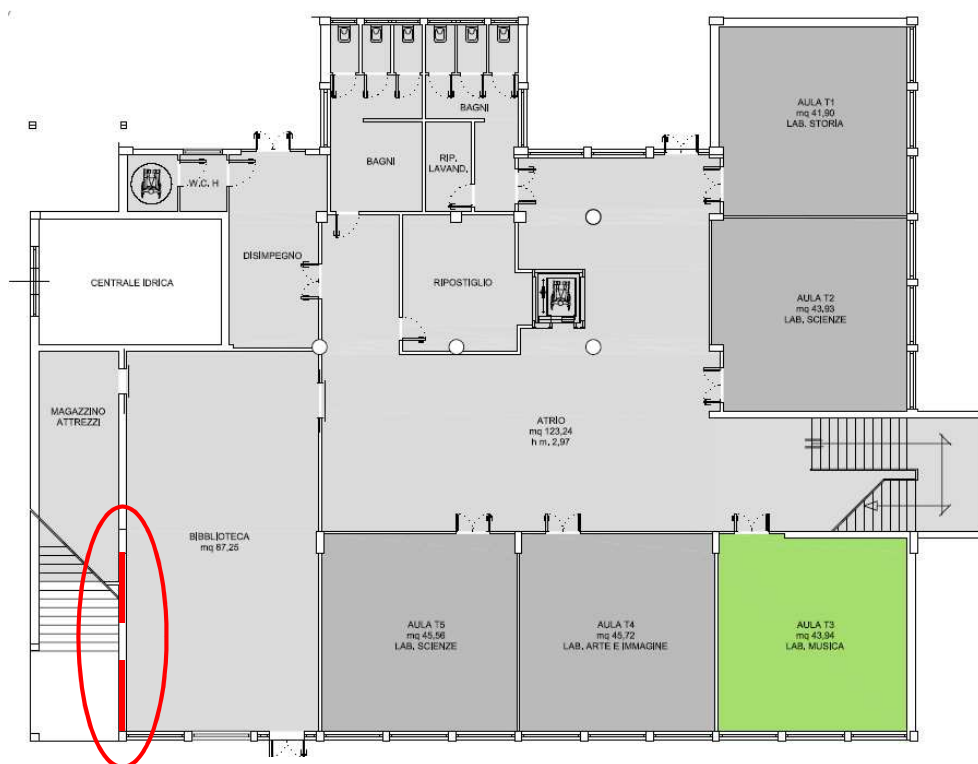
Plesso Nord: posizione nuove pareti in c.a.
